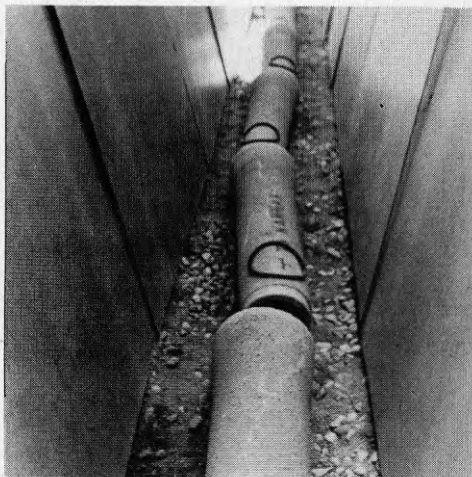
Utbärning av rör, metod 1, betongrör ø 225 mm.
